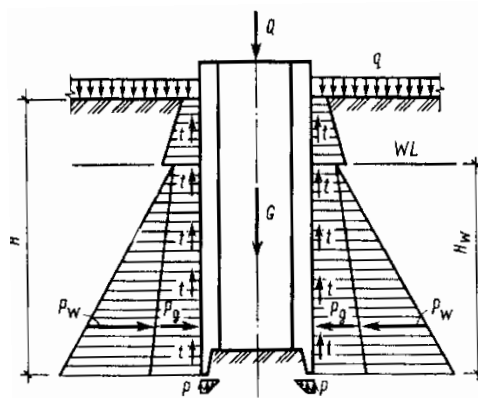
Схема нагрузок, действующих на опускной колодец во время его погружения
